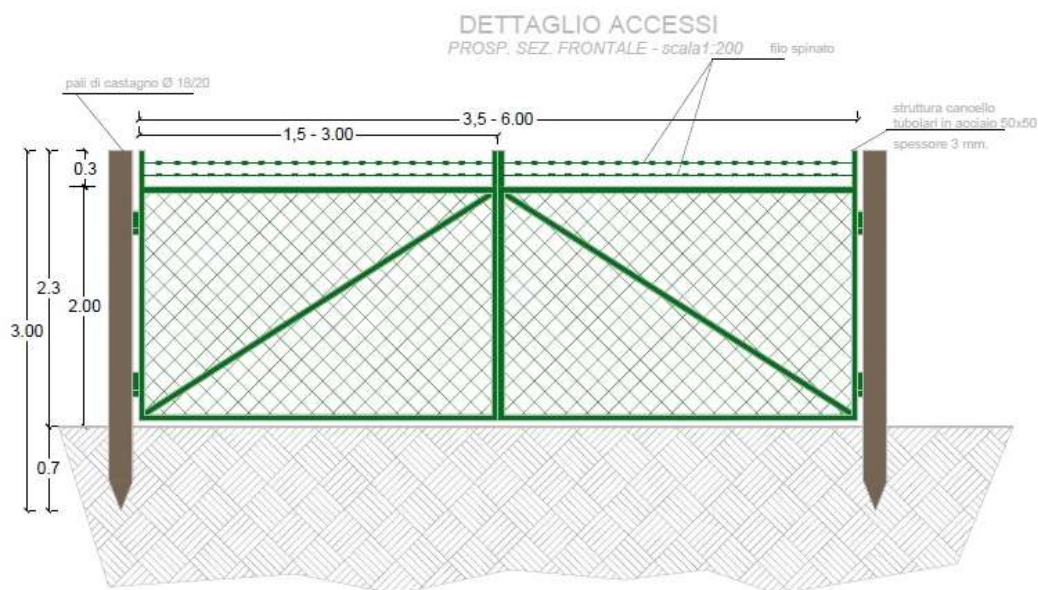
Prospetto della recinzione (dettaglio cancello di ingresso)
